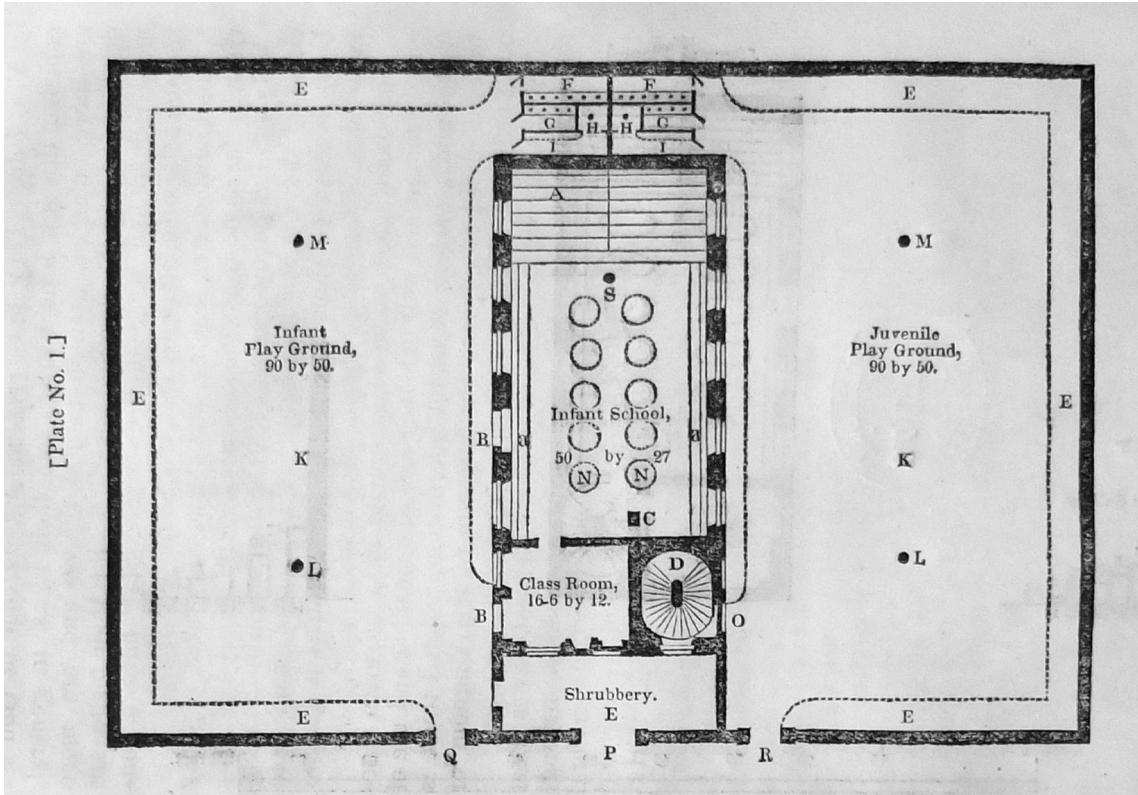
David Stow, Modellplan für eine Vor- und Grundschule, 1836
